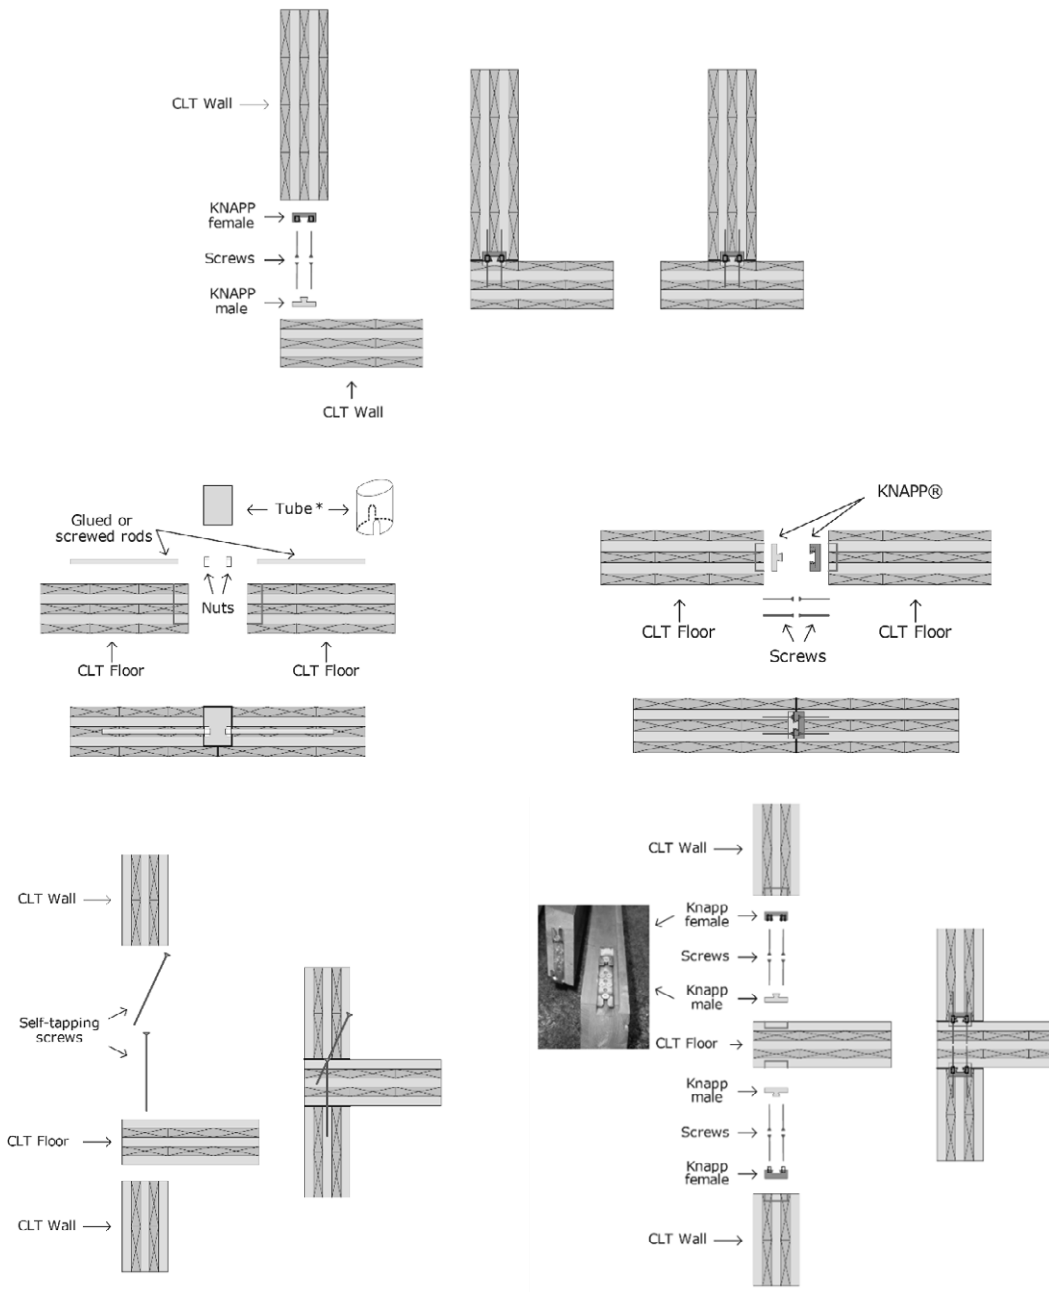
Sistema de ligação KNAPP entre duas paredes, adaptado de (FPInnovations, 2011)
